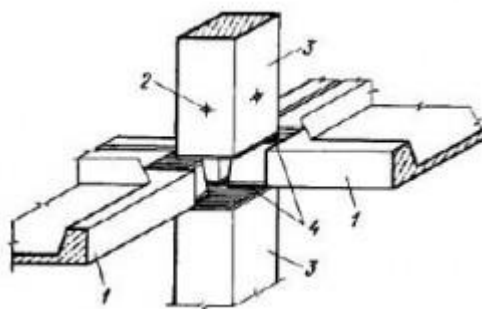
Конструкция стыка колонны с панелями покрытий при безригельном каркасе:
